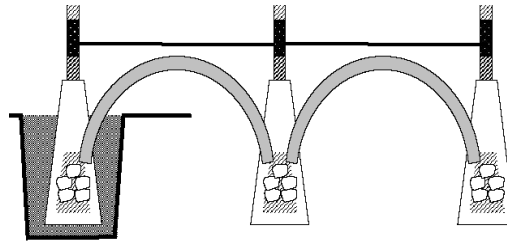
Bentuk rangkaian Pondasi Pijler menggunakan sloof
